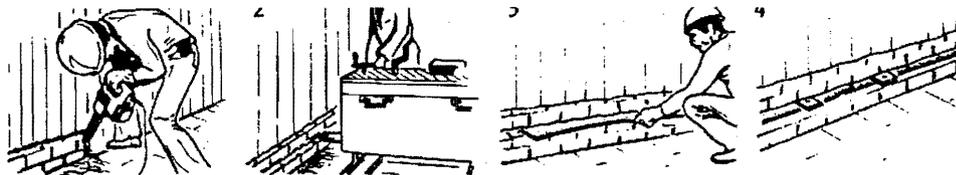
Colocación de barrera impermeable: 1) Retiro del aplanado existente; 2) Corte del muro, preferentemente con una máquina especial, y en tramas no mayores a un metro para evitar el debilitamiento del muro; 3) Inserción de láminas de impermeabilizante traslapadas y salidas del muro, colocación de mezcla de cemento; 4) Inserción de cuñas metálicas de anclaje.
